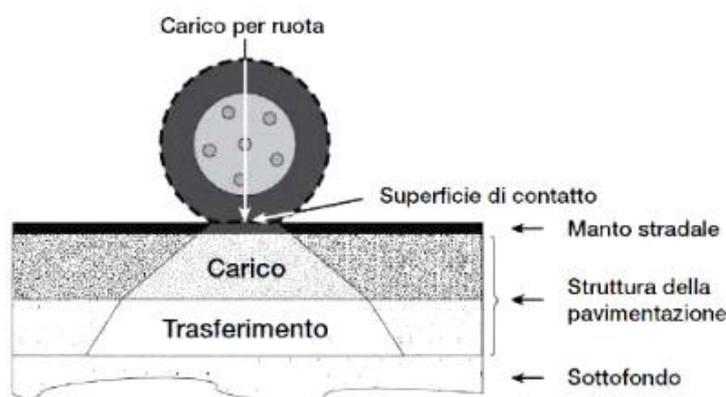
Struttura della pavimentazione stradale con relativo trasferimento di carico.
